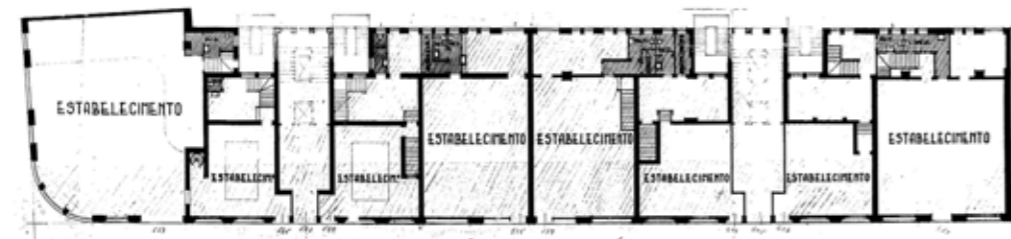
Planta de implantação do licenciamento nº 643 de 1948
